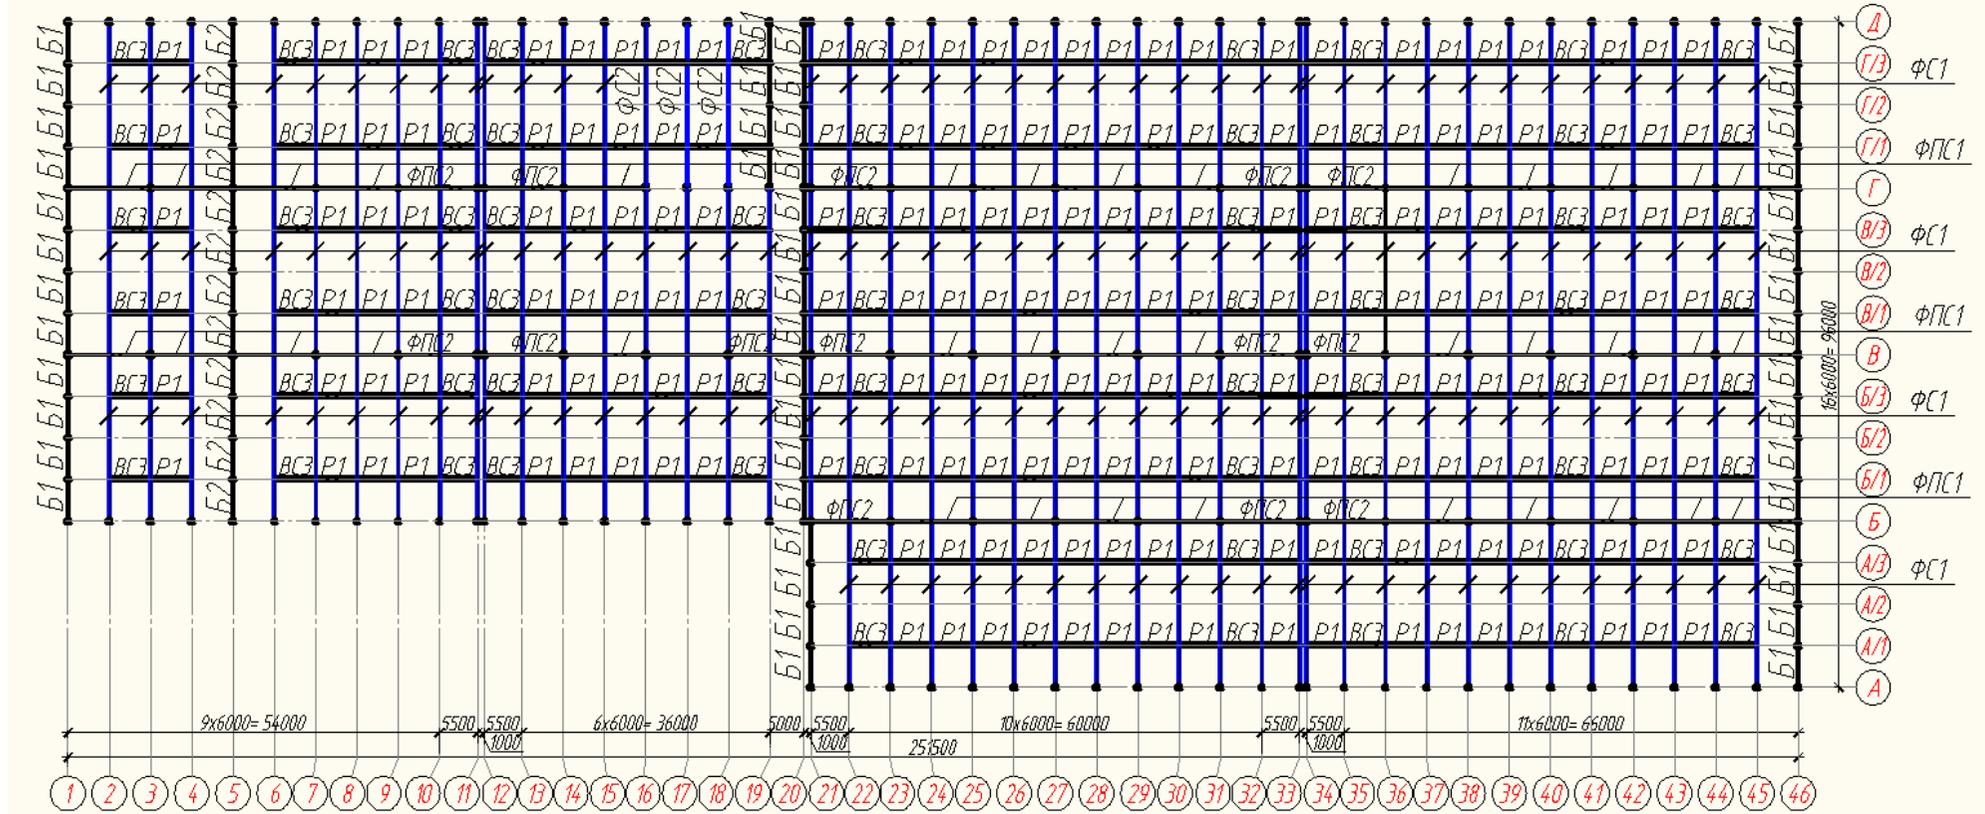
Схема расположения связей по верхним поясам стропильных ферм
